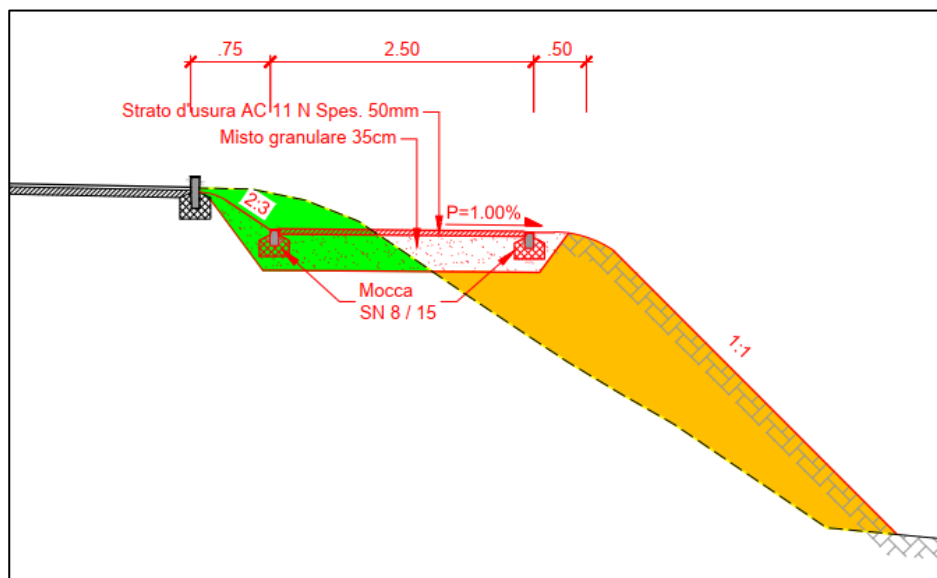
Sezione tipo del tratto lungo il Fiume Verzasca
